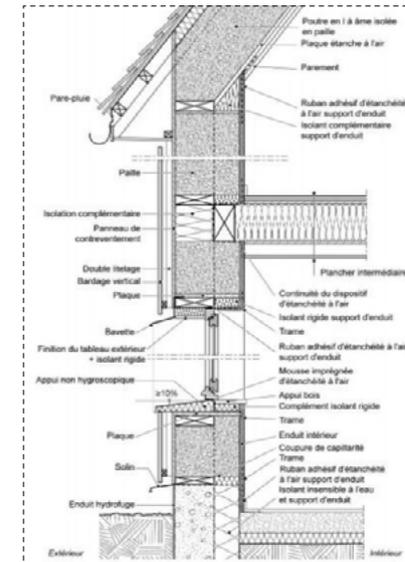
Exemple de coupe verticale d'une poutre avec ossature en paille décausée vers l'extérieur
